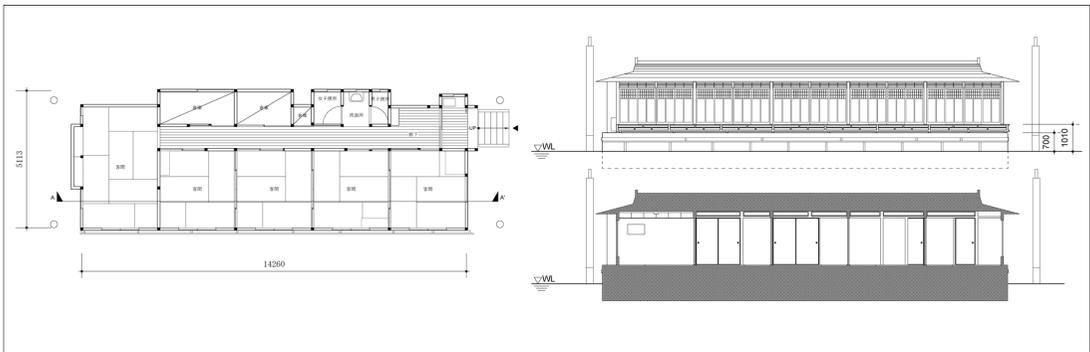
大阪「かき広」の平面図・立面図・断面図（現場での実測に基づき作図）
